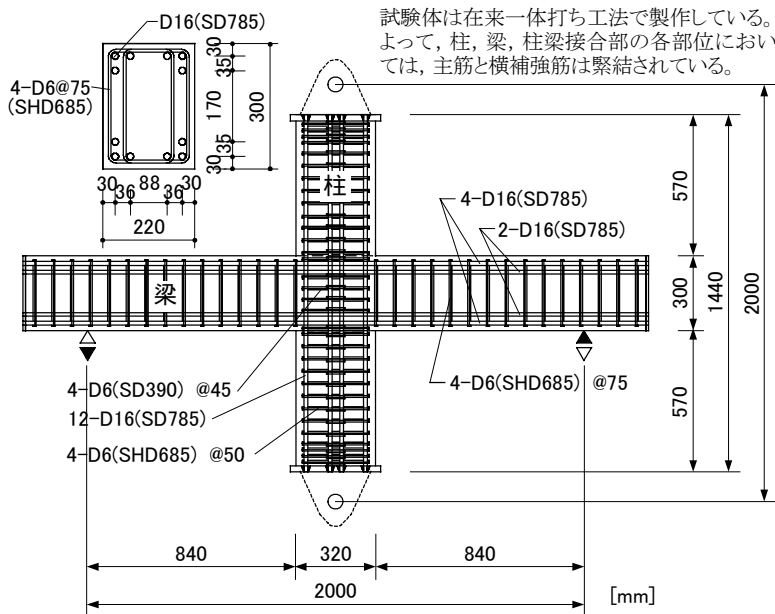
試験体の形状・寸法ならびに配筋(鉛直断面)
